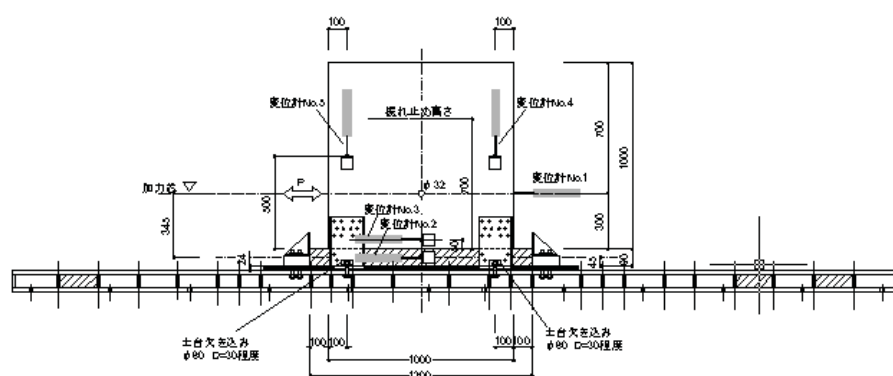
L型ビス用金物（純せん断）試験体立面図(L1-3)
